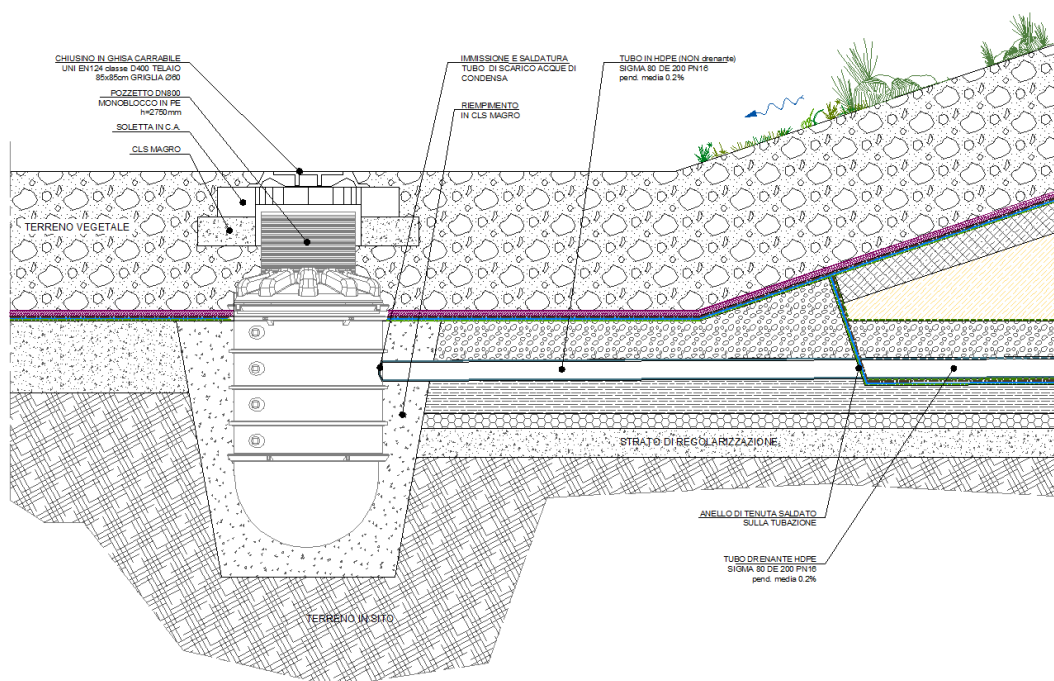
Sezione tipo raccolta condense e gas interni ai rilevati
